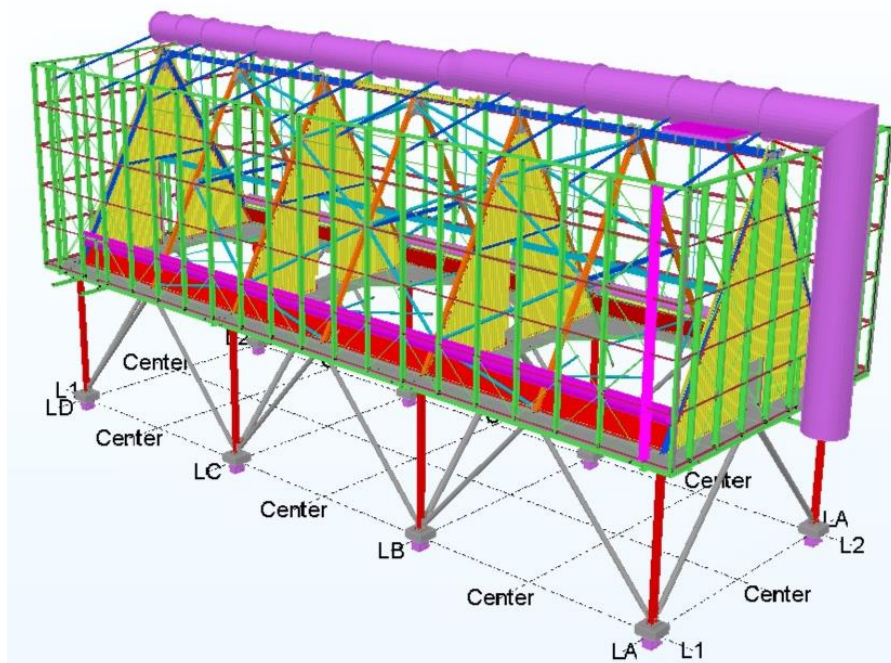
Modelação 3D em Tekla Structures da estrutura Condensadores (Araujo, 2017)
